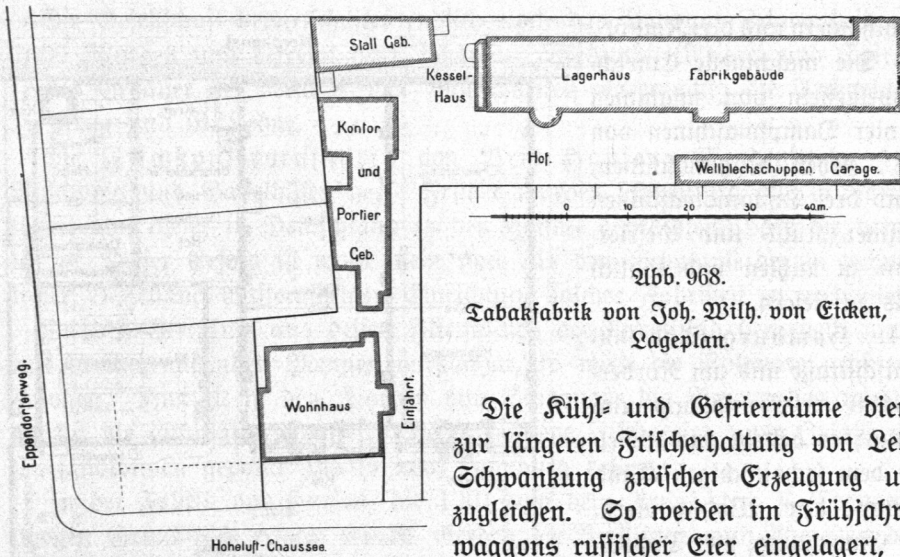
Tabakfabrik von Joh. Wilh. von Eicken, Lageplan.
